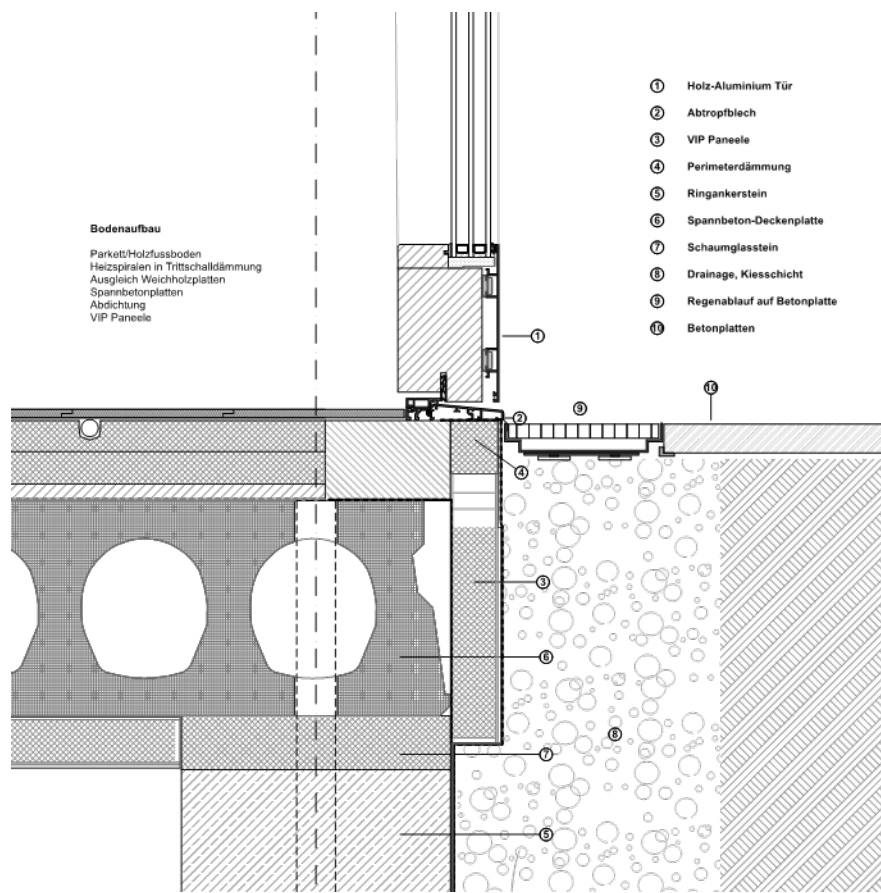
Türanschlussdetail (Prinzipdarstellung)
